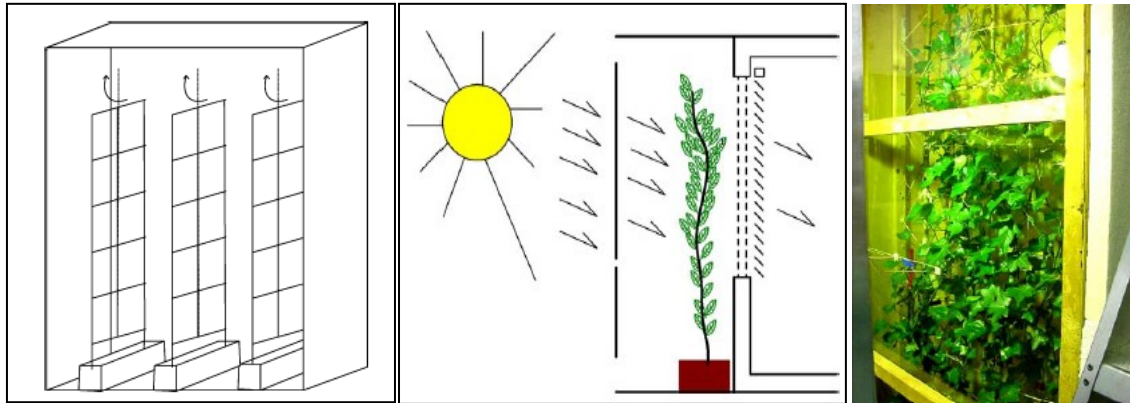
Installation des plantes et des stores dans la cavité de la façade.
